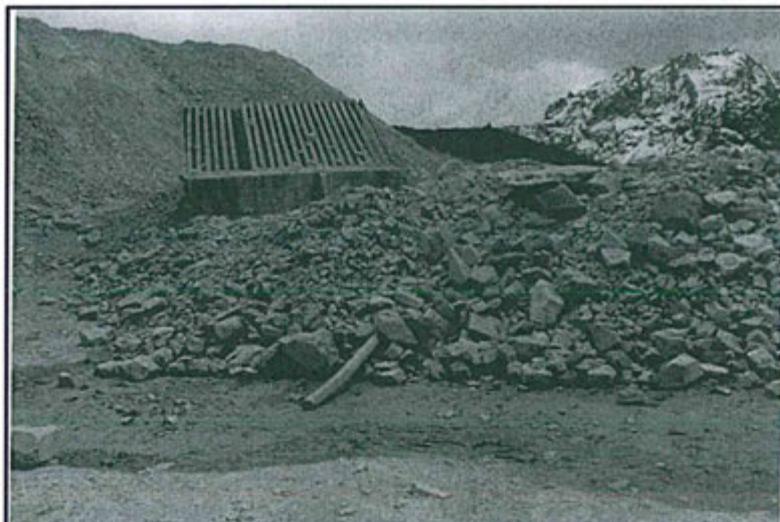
Vista del depósito de desmontes denominado en el Plan de cierre, Santa Catalina.
